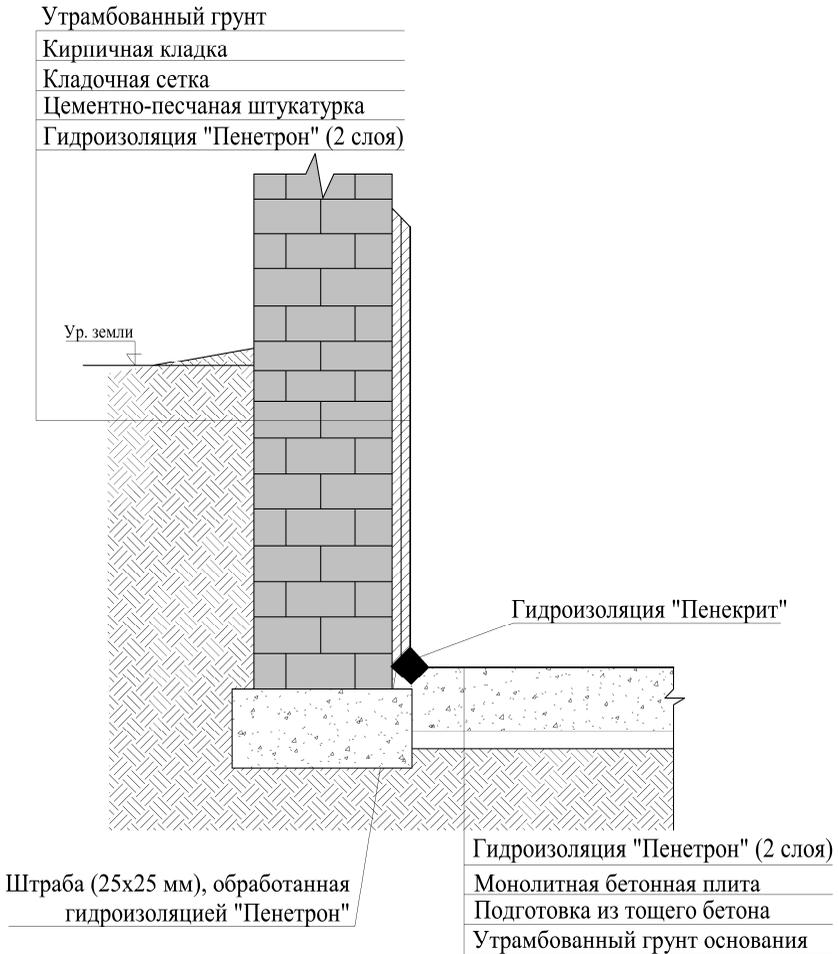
Б. Внутренняя гидроизоляция по кирпичной стене
